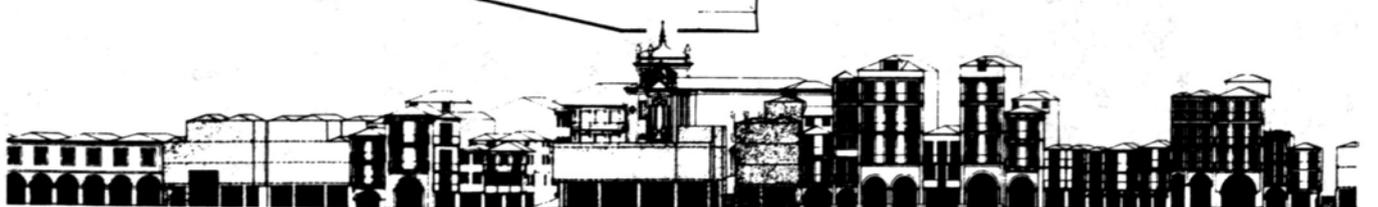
Planteamiento arquitectónico que integra la obra nueva de vivienda y el centro comunal a las construcciones existentes en proceso de recuperación. Zona de Miragaia. Brigada técnica Profesor Távora.
